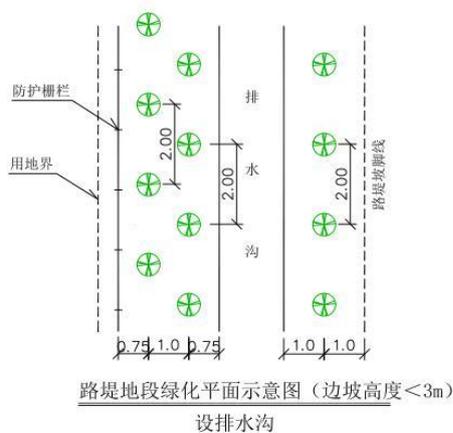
路基边坡坡脚绿化布设平面示意图
